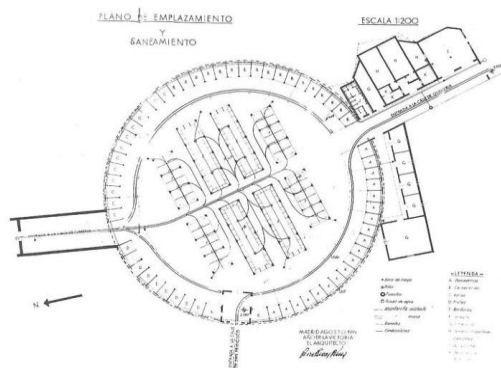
Plano de instalación sanitaria del mercado de Andújar. Andújar, Jaén, España. Fotografía de: www.arquitecturadeandujar.com
